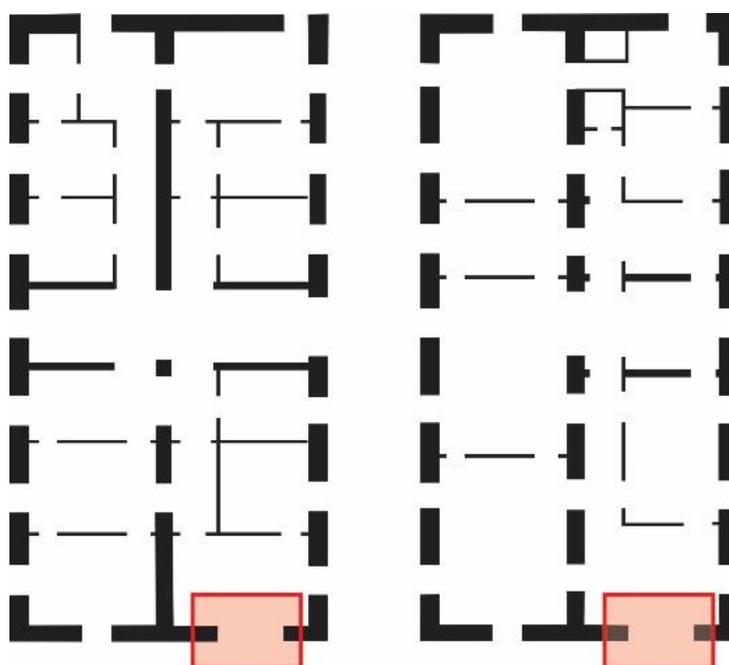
Provável Planta baixa do 1º pavimento (à esquerda) e do 2º pavimento (à direita) do Bloco II do PSC na época de D. João VI e de D. Pedro I. Destaque em vermelho para o vão que conecta o Bloco I com o Bloco II.
